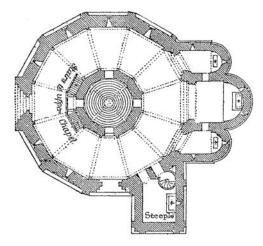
Segovia. Iglesia de la Vera Cruz, planta general (Street [1865] 1926)
